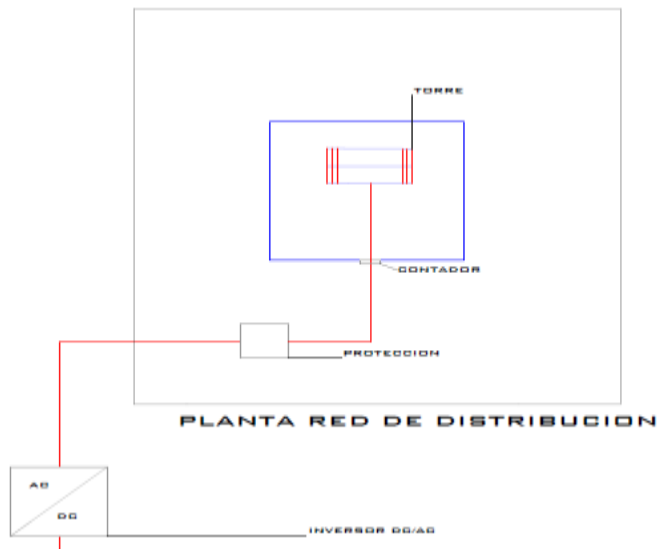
Distribución de Planta Paneles Fotovoltaicos
